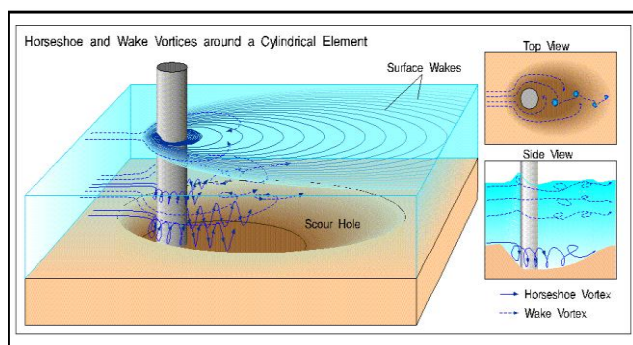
Phénomène d'affouillement au pied d'une pile de pont [92]
